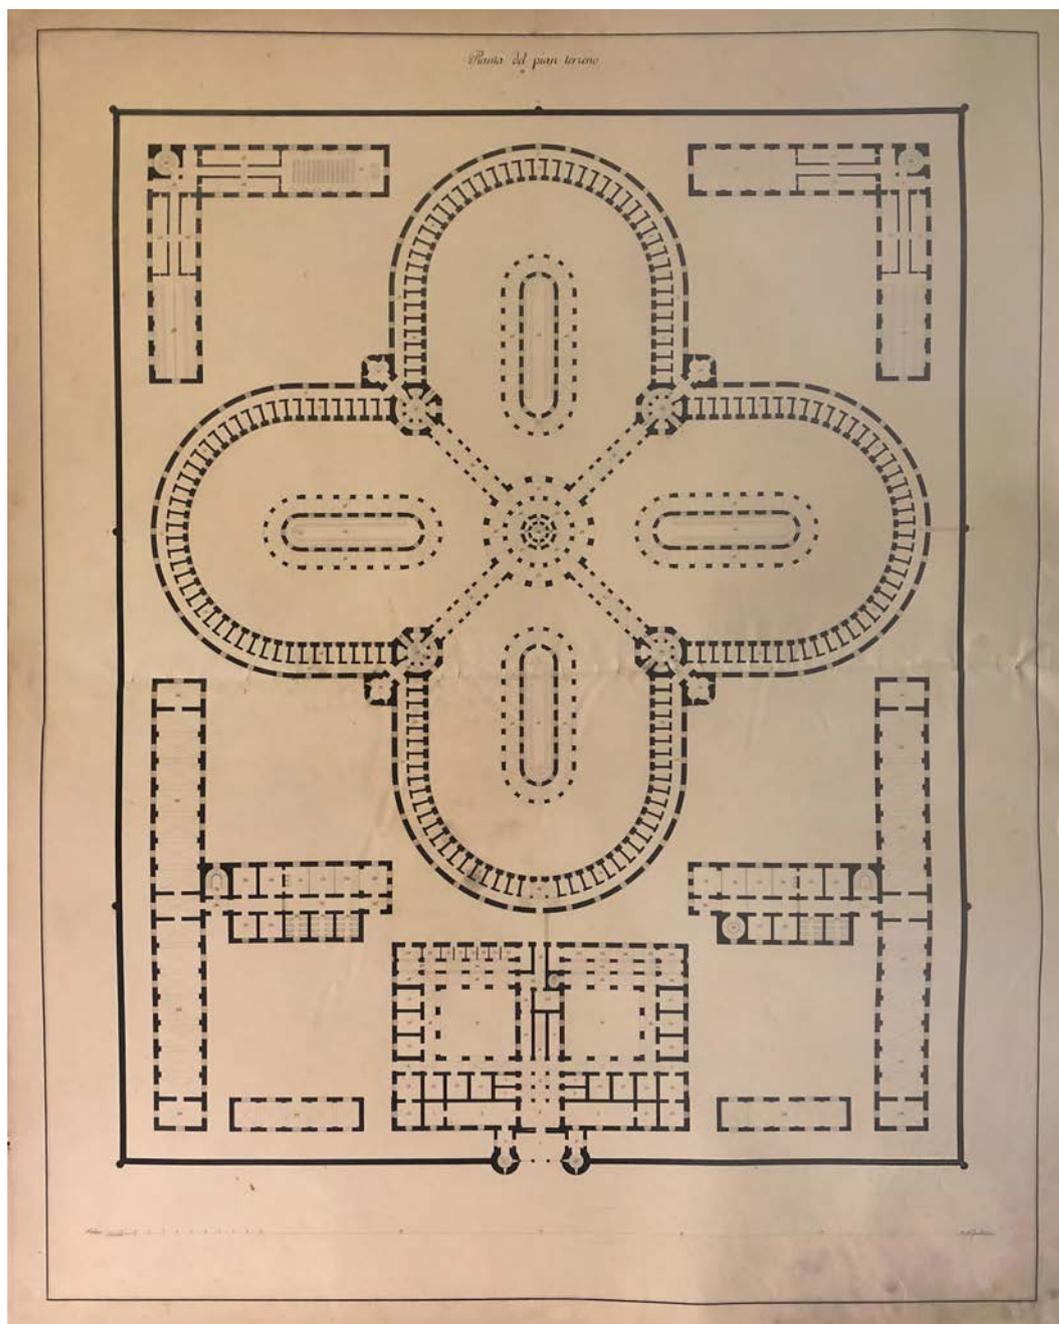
O. Angelini, Progetto del carcere centrale da costruirsi in Napoli. Pianta del pian terreno, 1841 ca. Collezione privata.
